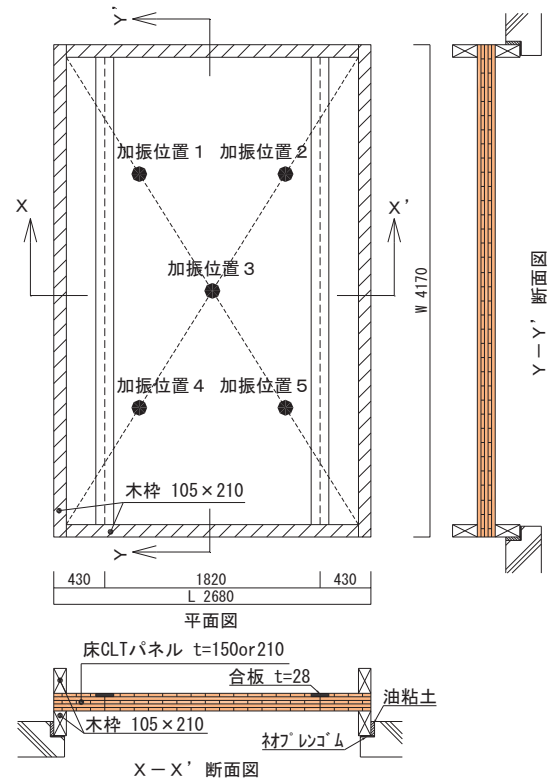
試験体の平面図・断面図および加振位置(寸法単位:mm)
